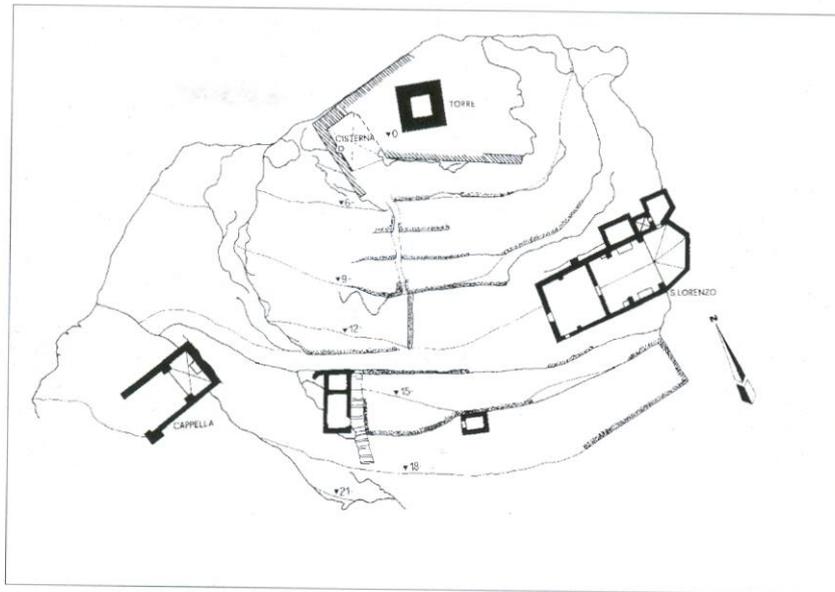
Planimetria del castrum di Orco (dis. di Bruna Ugo).
